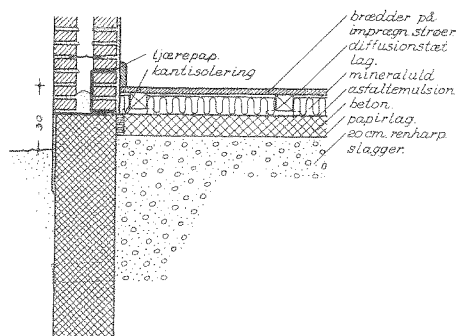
Denne gulvkonstruktion kan anvendes, når huset ligger tørt, gulvbelægningen ikke er dampstæt, og isoleringen over betonpladen ikke kapillarsugende. Det må dog i alle tilfælde tilrådes at stryge betonpladen med kold asfalt. Lige under gulvbrædderne lægges et lag dampstæt papir.
